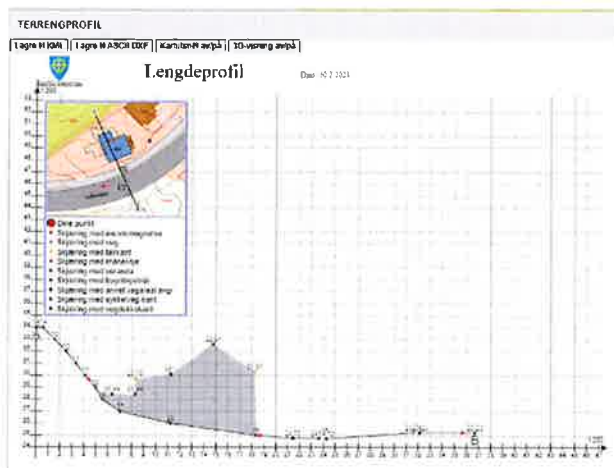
Lengdeprofil av eksisterende av eksisterende bebyggelse på planområdet.
